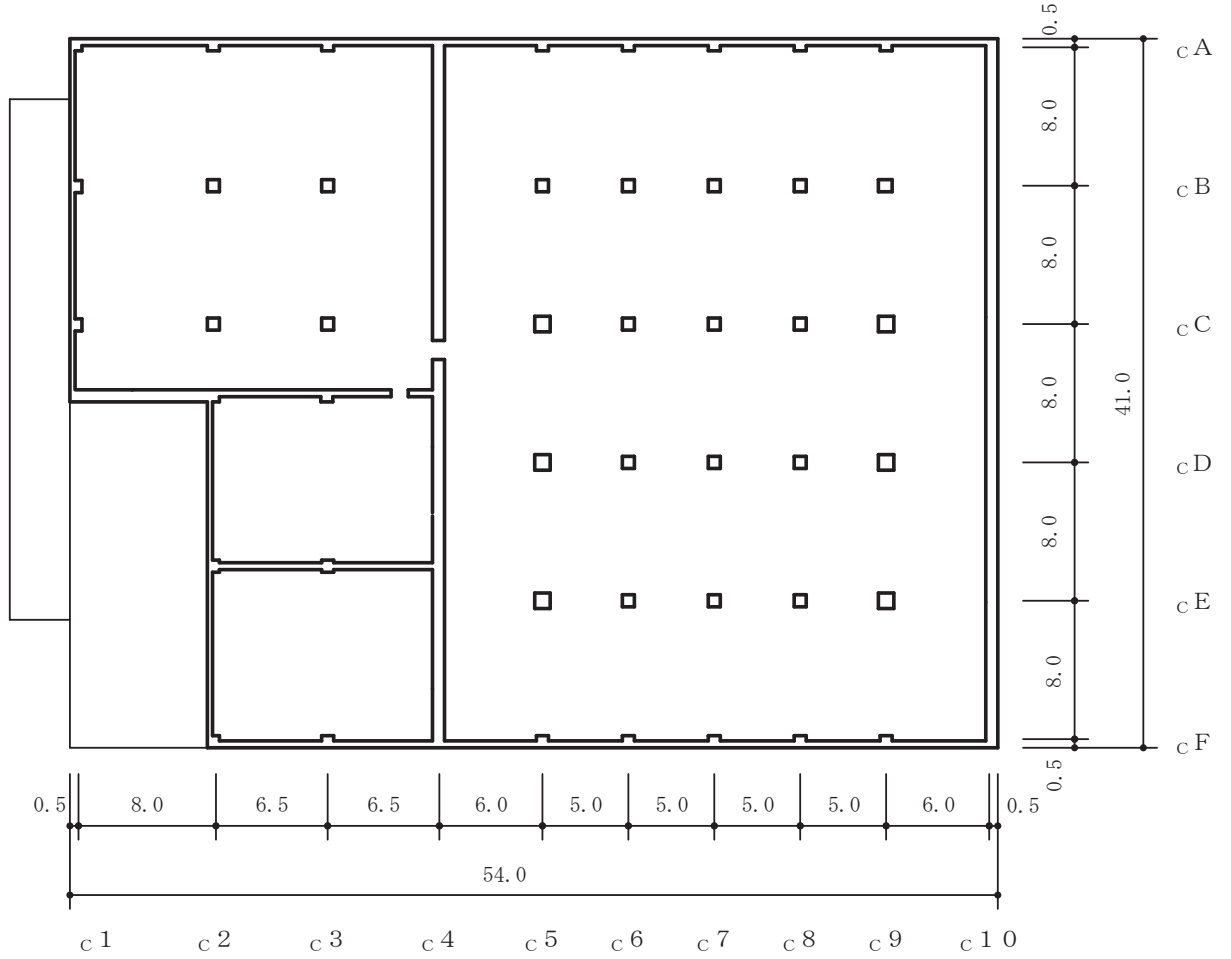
(2) 第 1 号機制御建屋の概略平面図 (0. P. 5. 0m)
